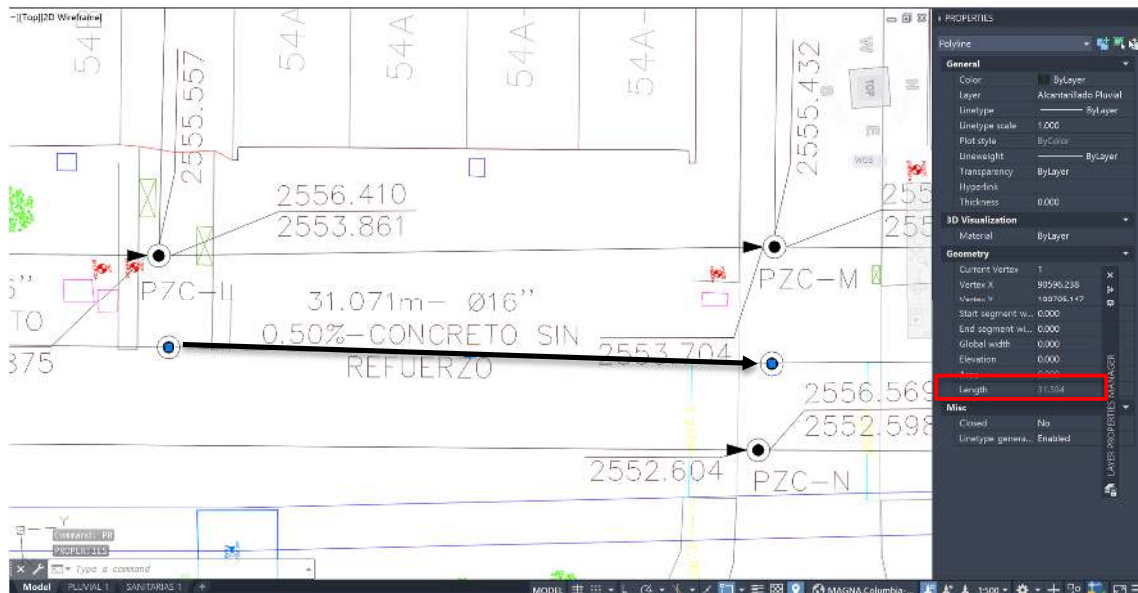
Cuantificación de longitud alcantarillado pluvial D 27".
